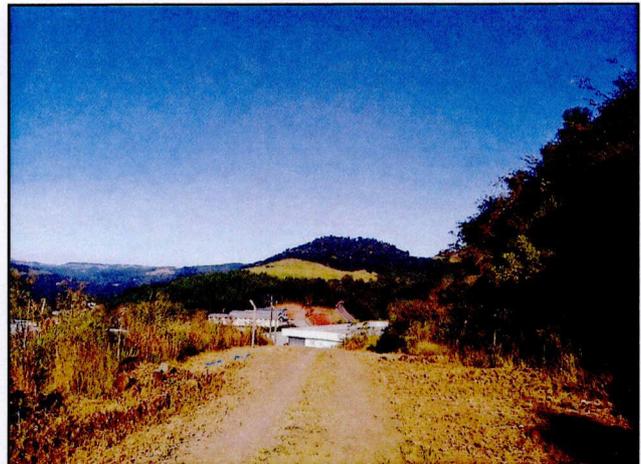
vista sul do leito da Rua existente a ser regularizada, conforme ponto 02 do projeto;
